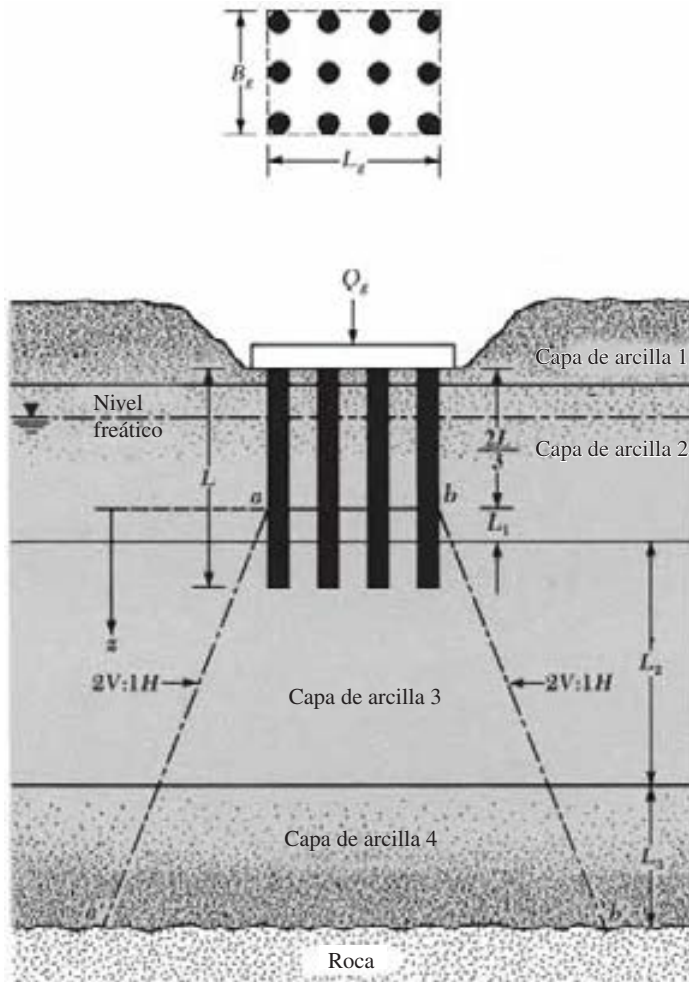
Asentamiento de consolidación de un grupo de pilotes
